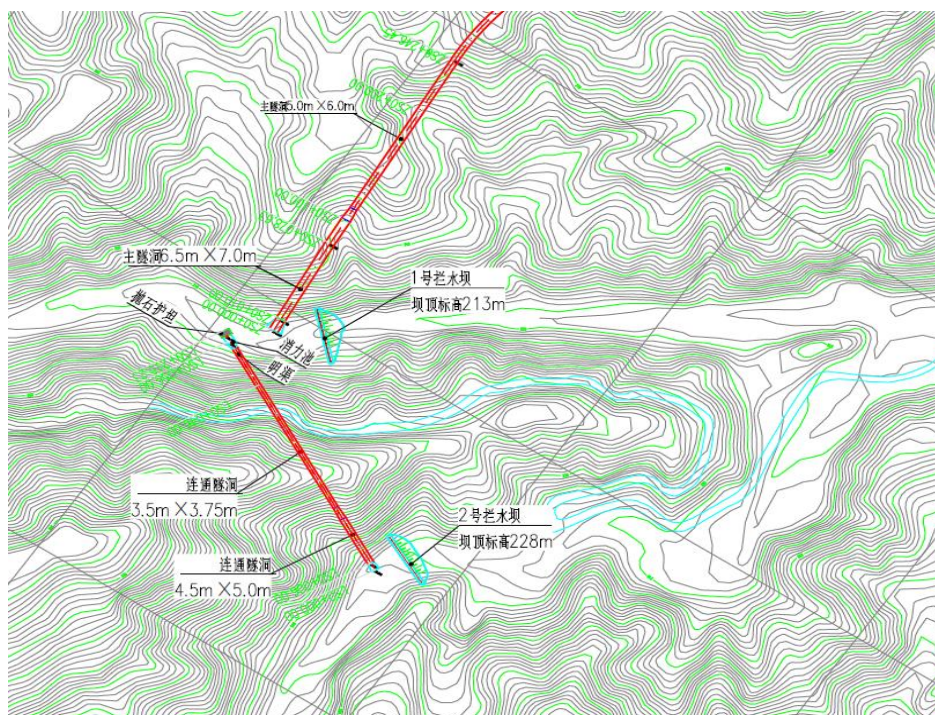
排土场上游防排水系统平面布置图（变更后）
